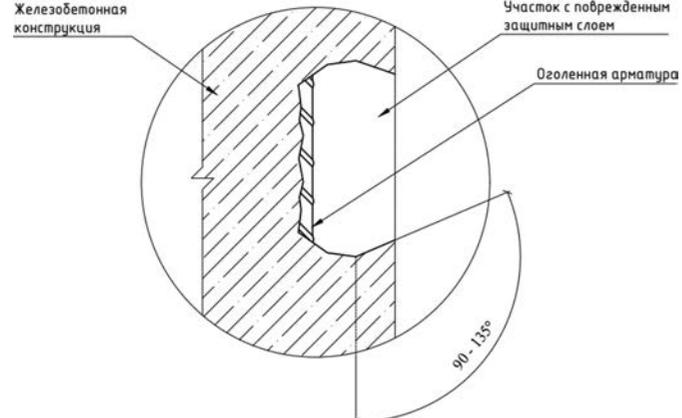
Разрушенные участки бетона с оголенной арматурой
